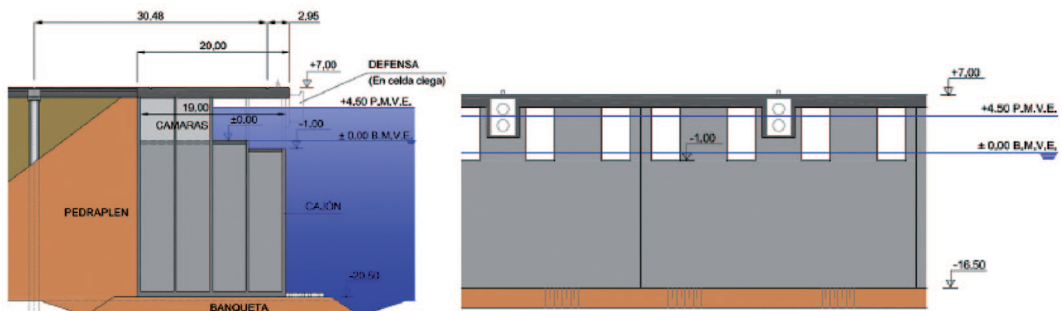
Sección transversal (izda) y alzado (dcha) de la Alternativa 2.
